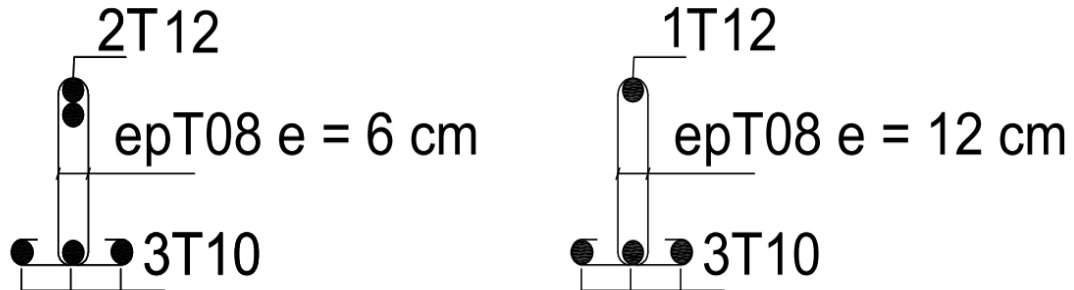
Ferrailage des poutrelles en appuis et en travée.
